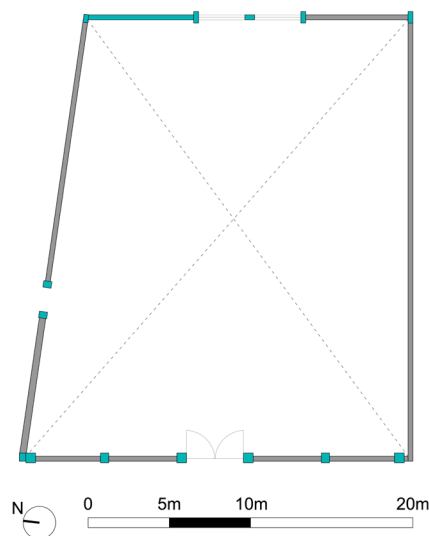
Planimetría Galpón Poniente Ex Fundición Metalco. Fuente: elaboración propia.
